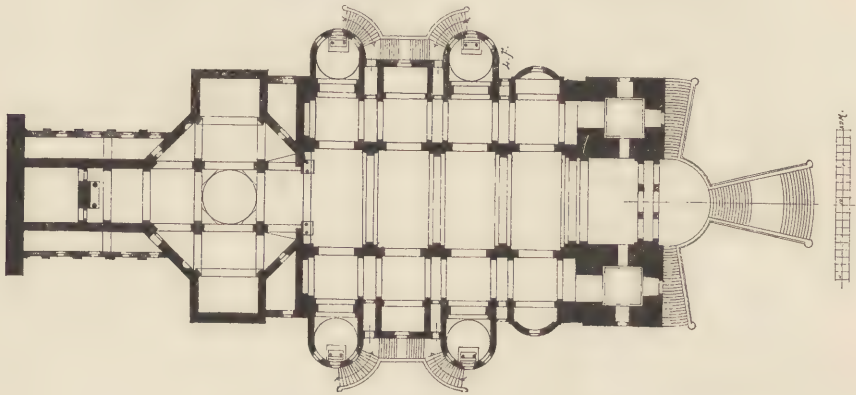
Dom zu Kempten. Grundriss.
